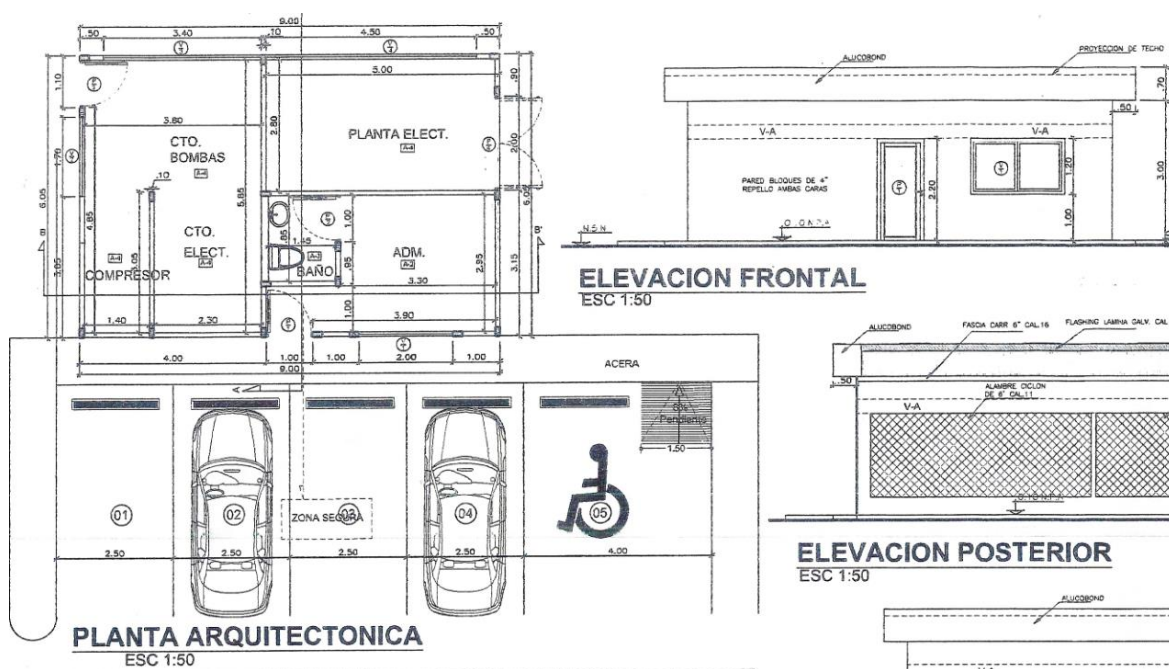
Planta arquitectónica de la Oficinas y estacionamientos
